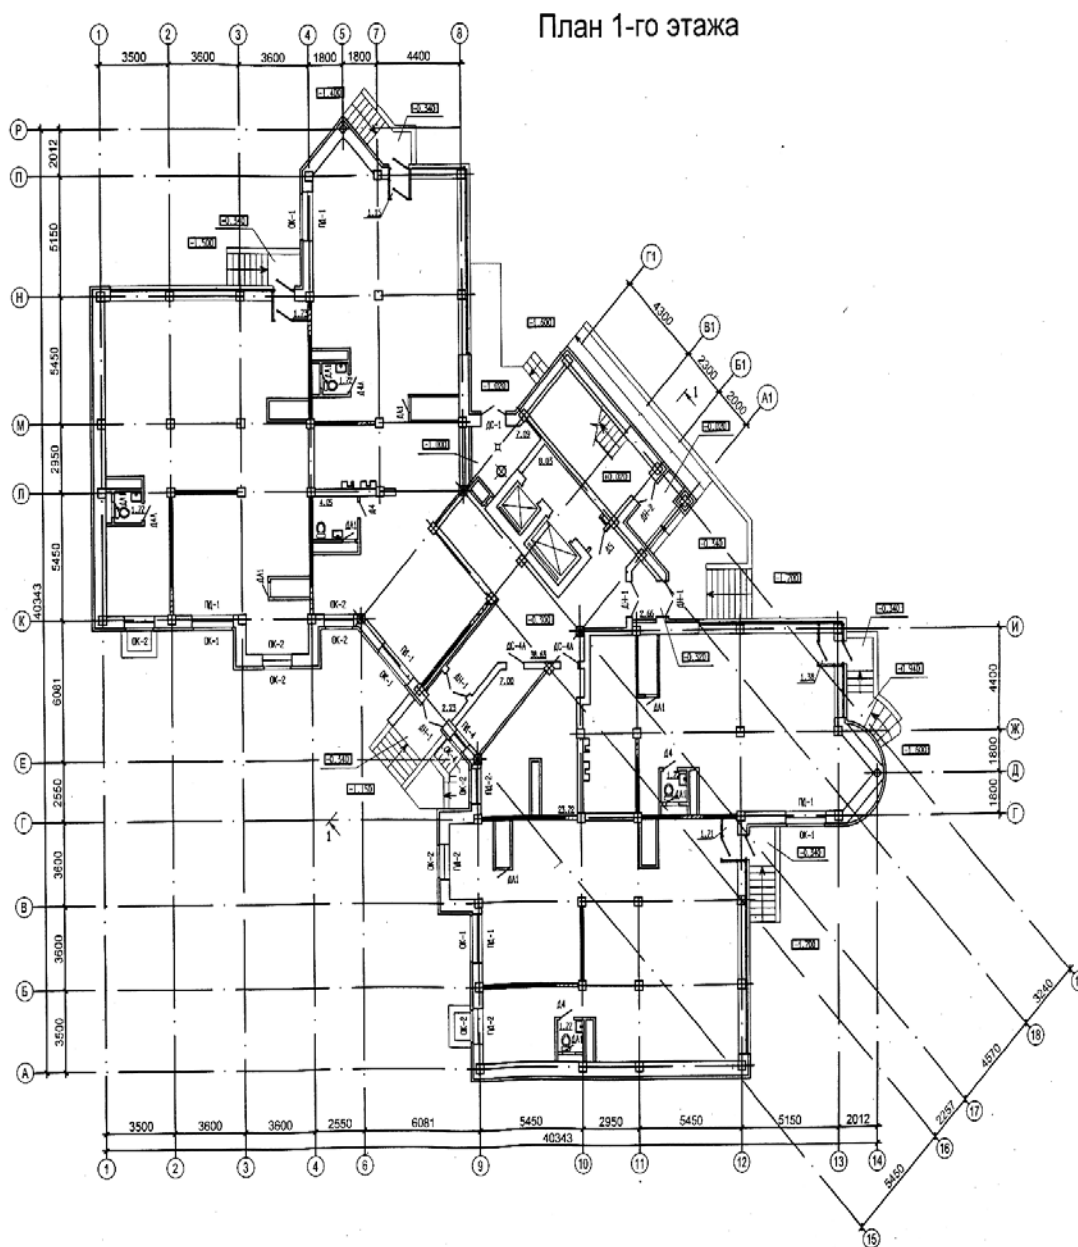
План первого этажа жилого 17-ти этажного монолитного дома со встроенными офисными помещениями и лестнично-лифтовым узлом с незадымляемой лестничной клеткой Н1
